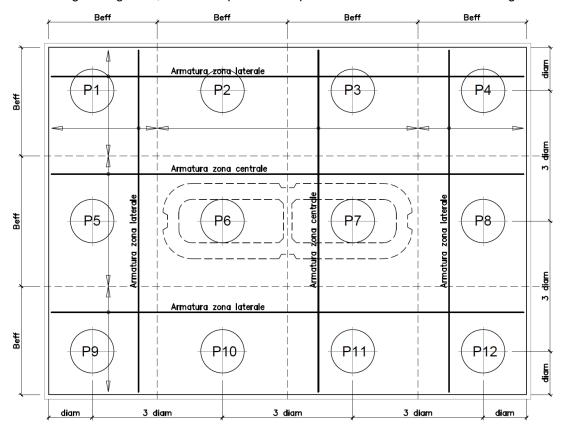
Plinto di fondazione – Armatura longitudinale inferiore e superiore II tirante d'armatura impiegato nelle verifiche è descritto nella tabella seguente.
